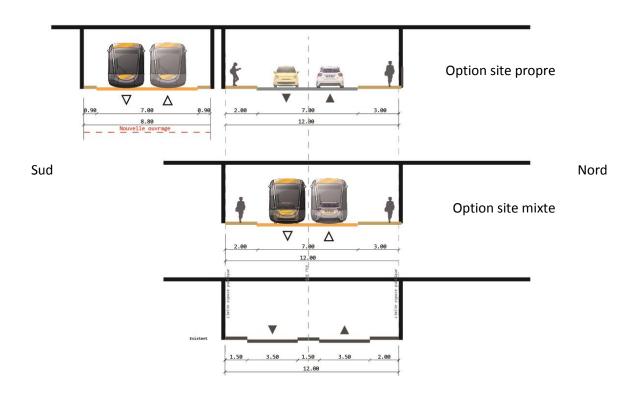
coupe d'insertion au niveau de l'ouvrage de la voie ferrée
